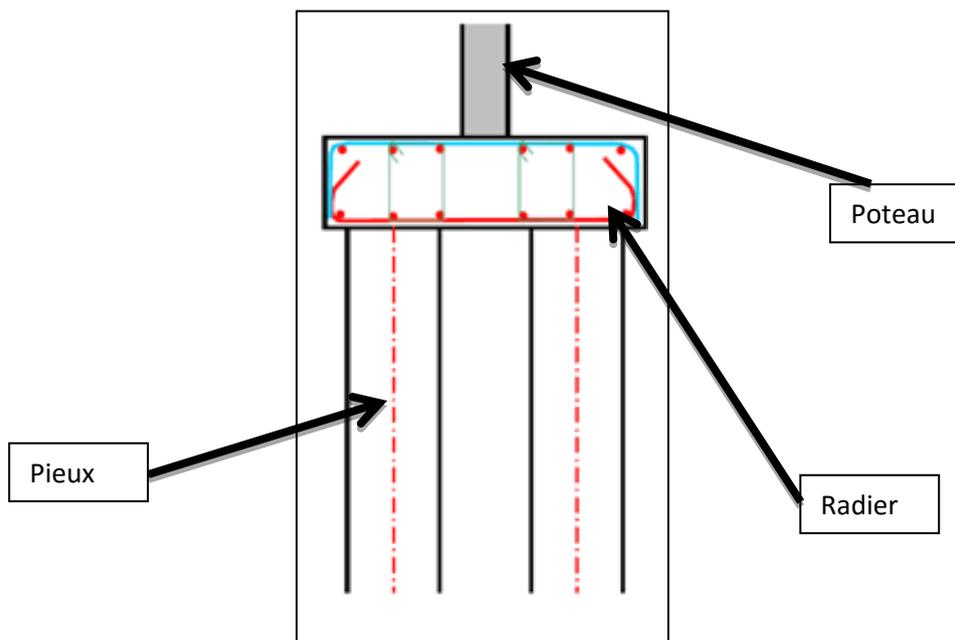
coupe transversale d'un poteau supporté par 2 pieux
